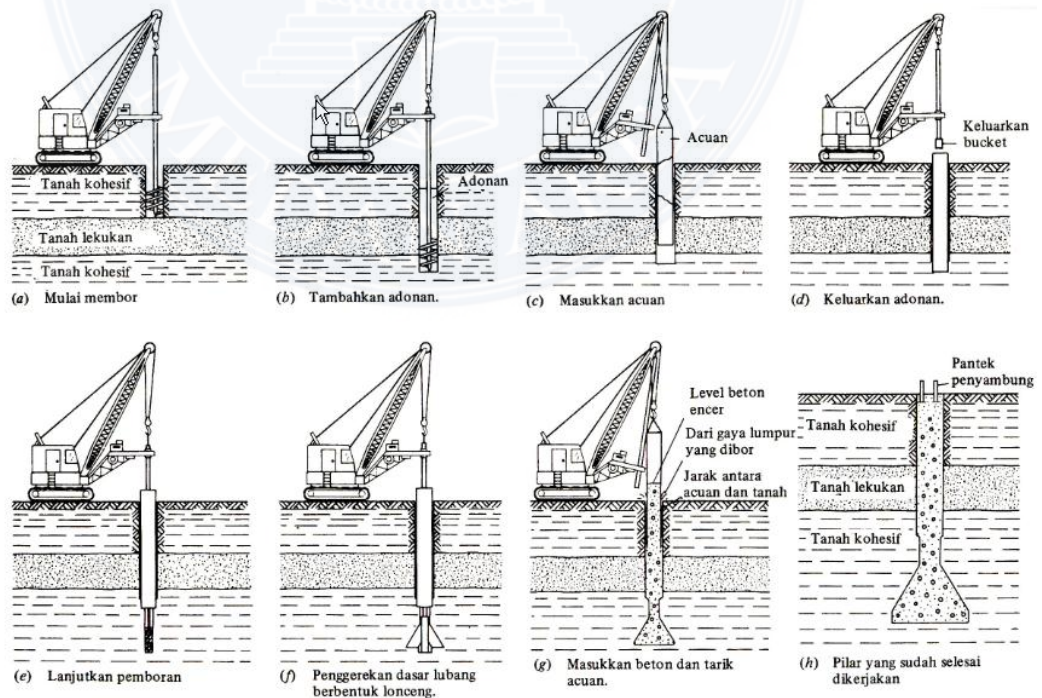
Metode kering konstruksi pilar yang dibor
